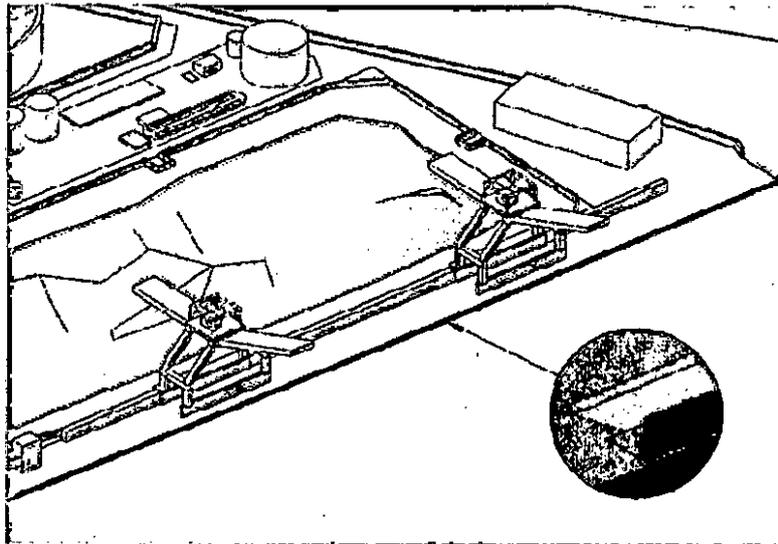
Vista dall'alto della banchina con installazione barriera di contenimento
